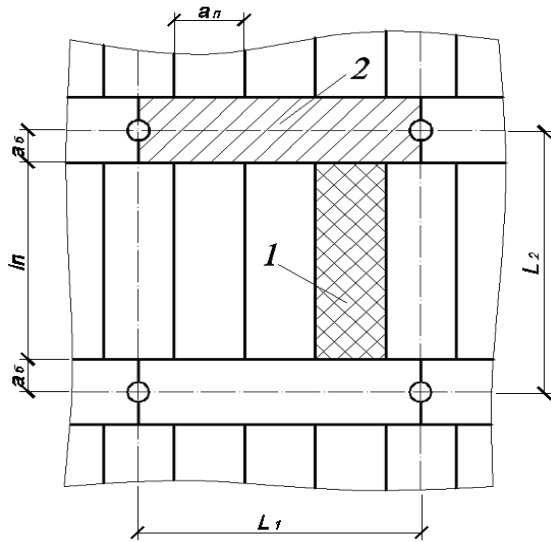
Фрагмент сталезалізобетонного безбалкового перекриття: 1 – другорядний диск; 2 – головний диск.
